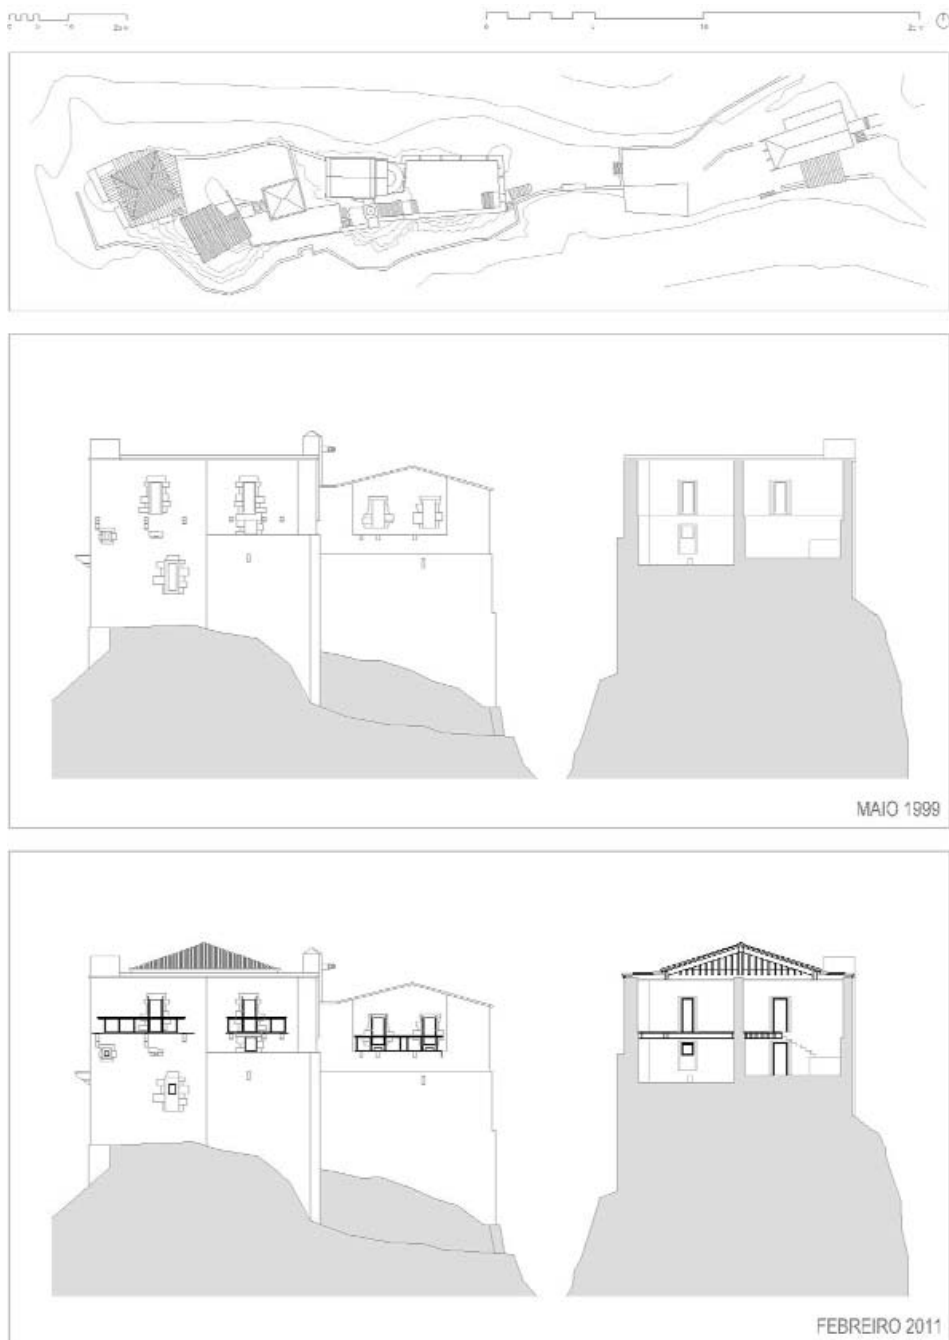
CAAVEIRO. Alzado oeste e sección transversal da Casa de Quintás (Pavillón de exposicións).
